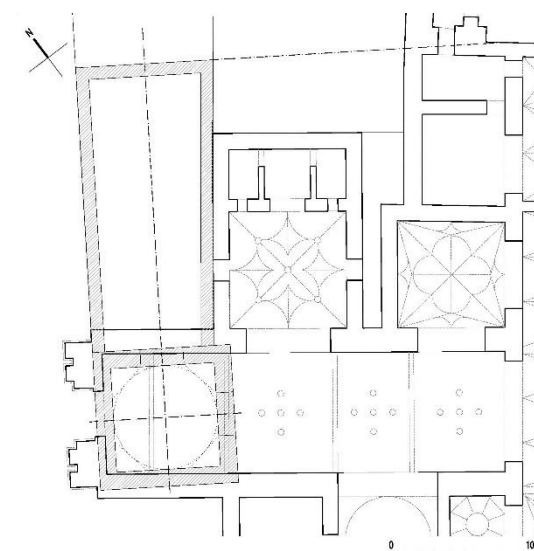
Propuesta de planta de la iglesia primigenia. Convento de Santo Domingo. Jerez.
